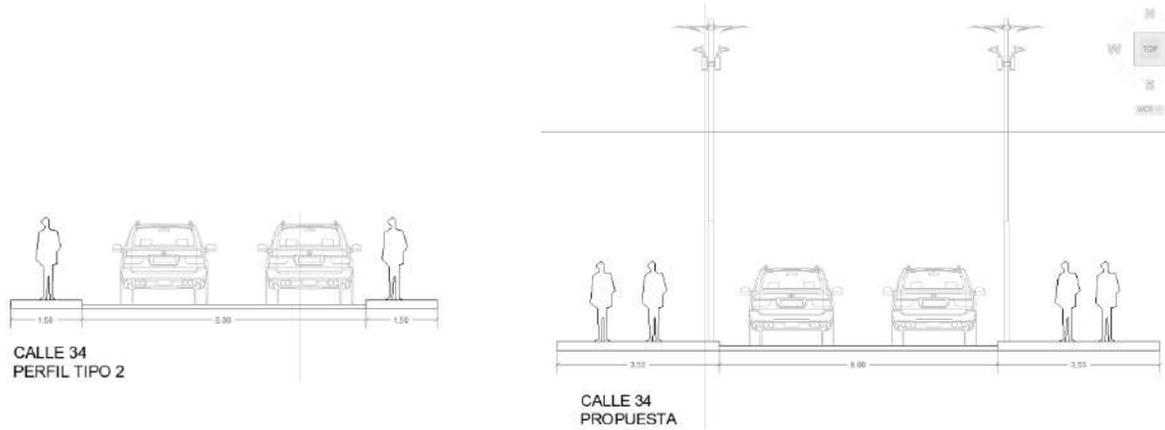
Nota: Propuesta de ampliación vial en la calle 34. Fuente: Elaboración propia. (2022)
